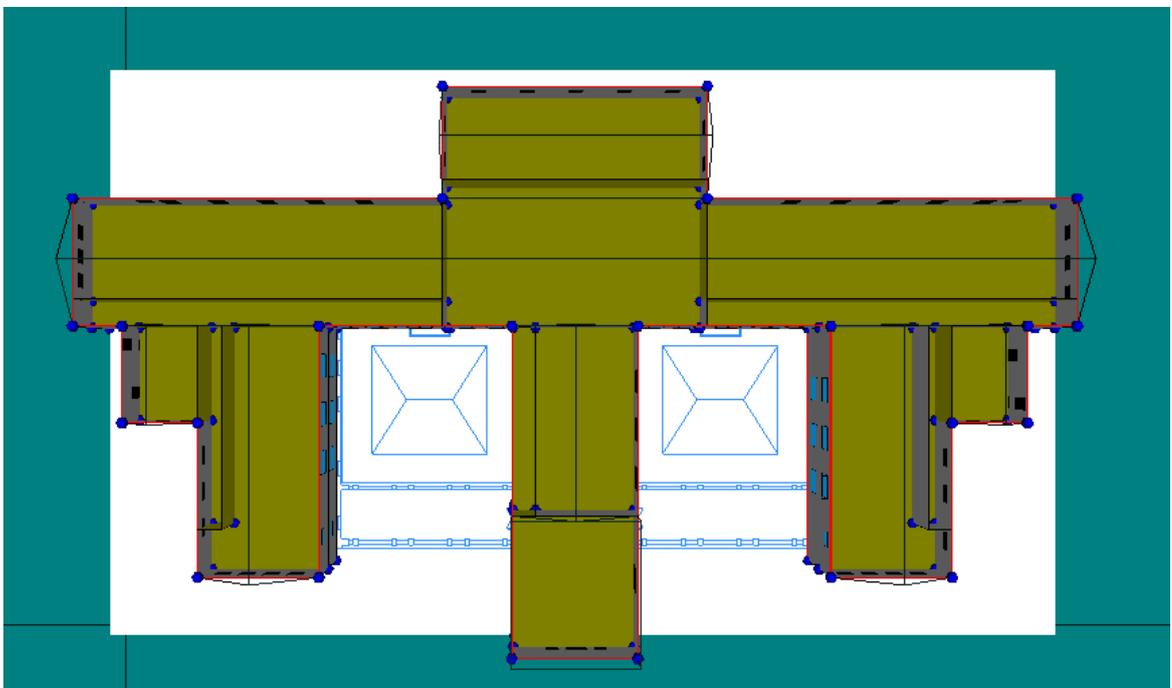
Planta baja del cuartel. Fuente CalenerVYP
